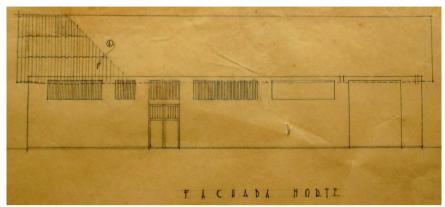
Edificios existentes - Fachada norte. Código 4670, 1945 Fuente: Archivo planimétrico Cornelissen & Salzedo, 2017
